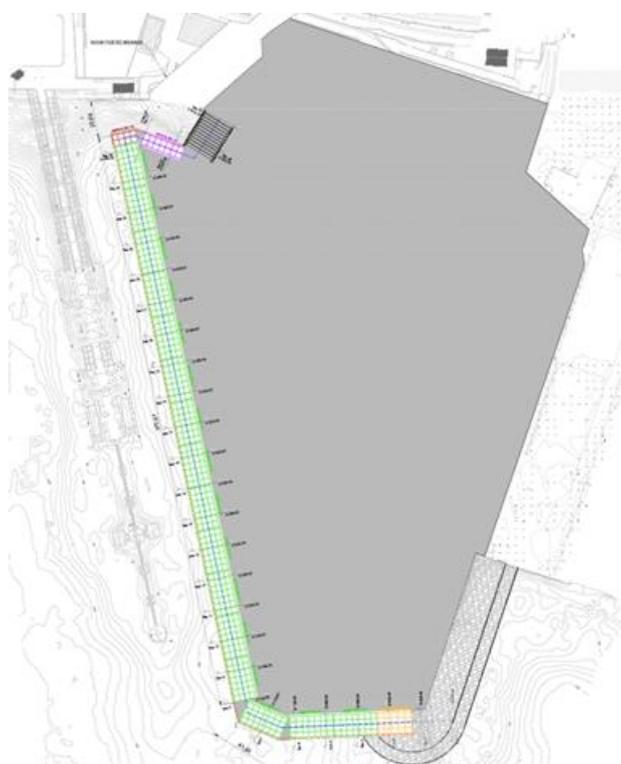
Stralcio della planimetria di progetto con individuazione dei cassoni (realizzati in Fase 1) sui quali sarà realizzata la struttura perimetrale (al netto di variazioni/modifiche sul palancolato)
